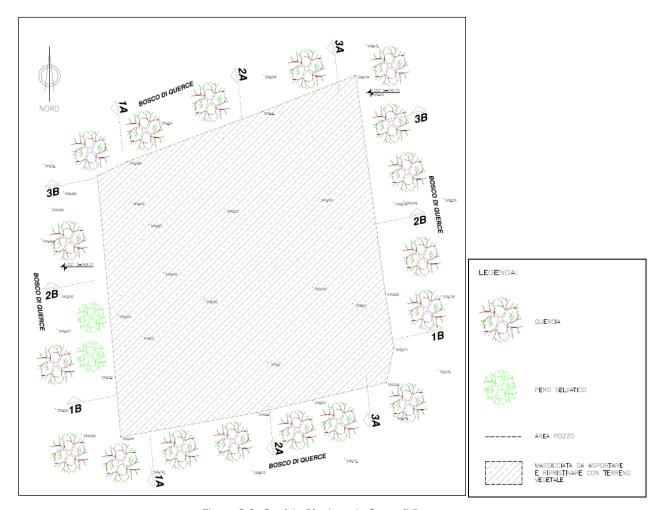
Stralcio Planimetria Stato di Progetto.
